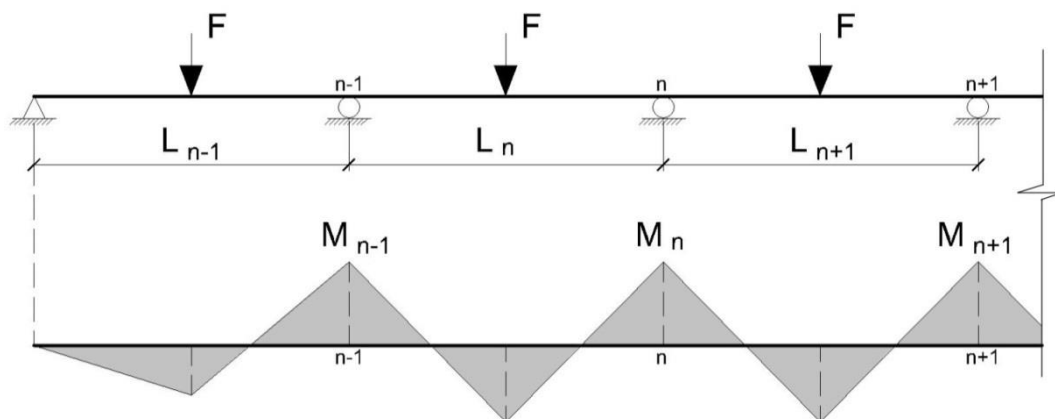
Розрахункова схема багатопролітної нерозрізної балки
